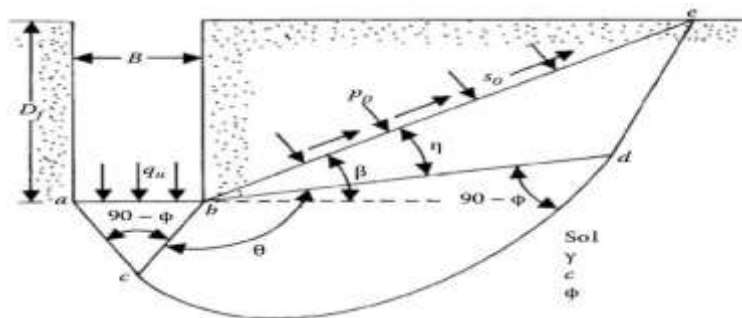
Champs de ligne glissement pour une fondation rugueuse continue.
